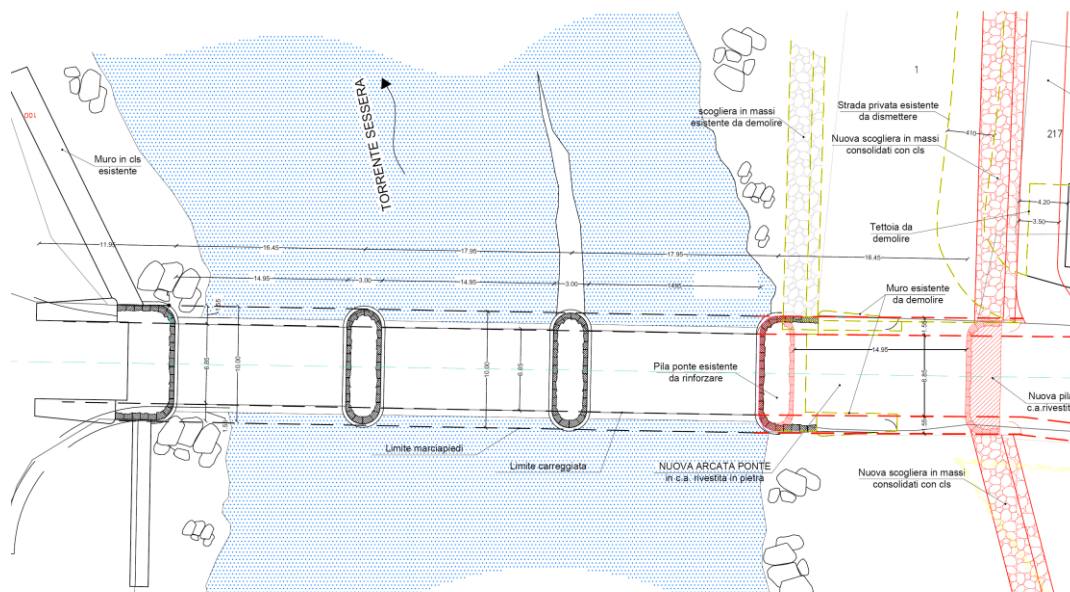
Schema planimetrico di maggior dettaglio dell'intervento di apertura della quarta campata del ponte di Panceri
